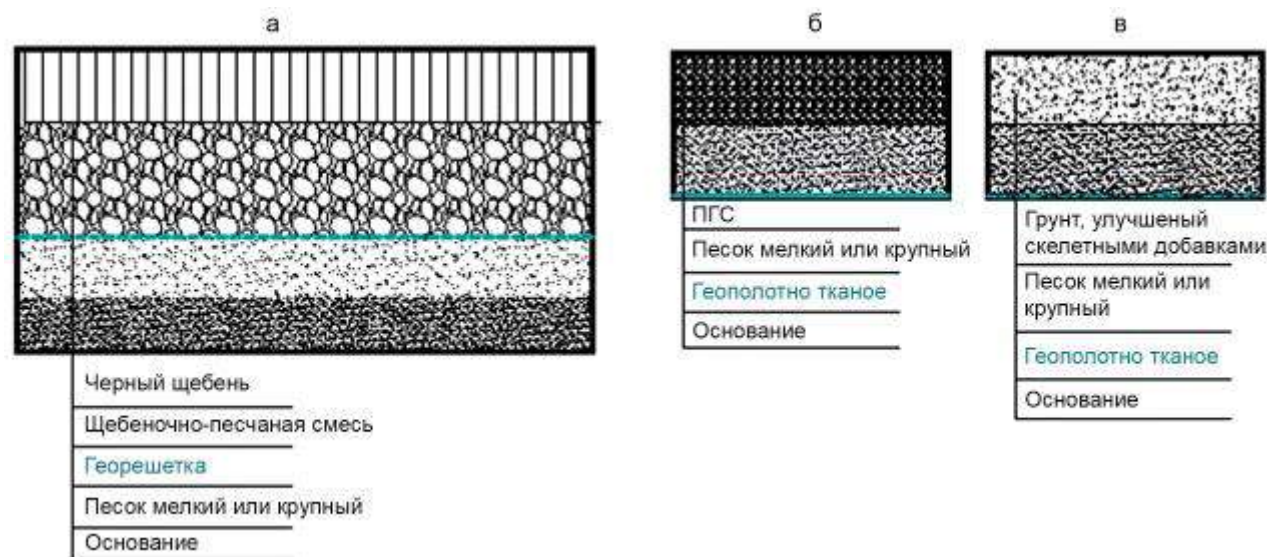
Рекомендуемые дорожные конструкции с жестким покрытием для площадок перегрузки древесины
